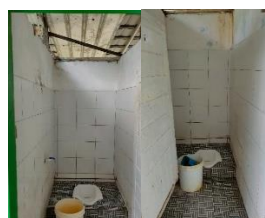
Ventilasi Pada Ruang Toilet Kedua
